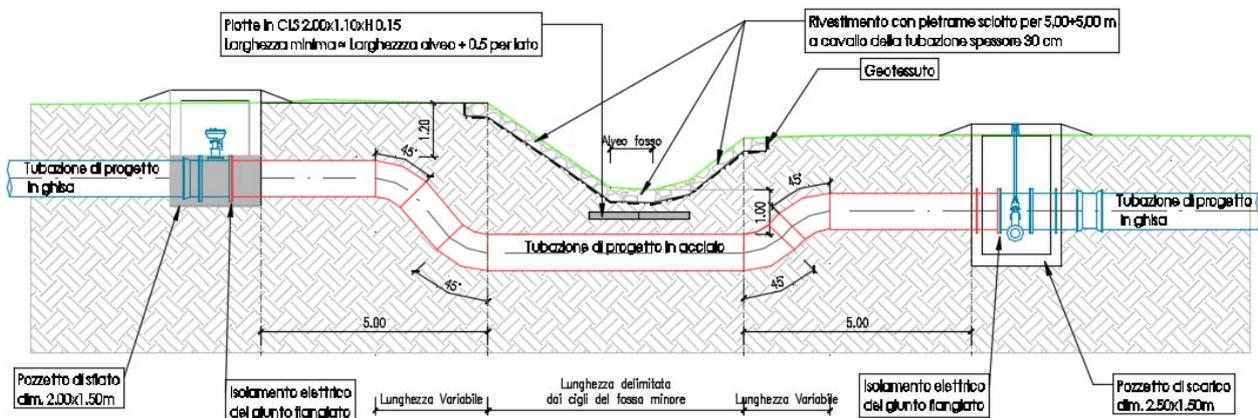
Sezione tipo di attraversamento di uno scolo consortile con sifone in acciaio
